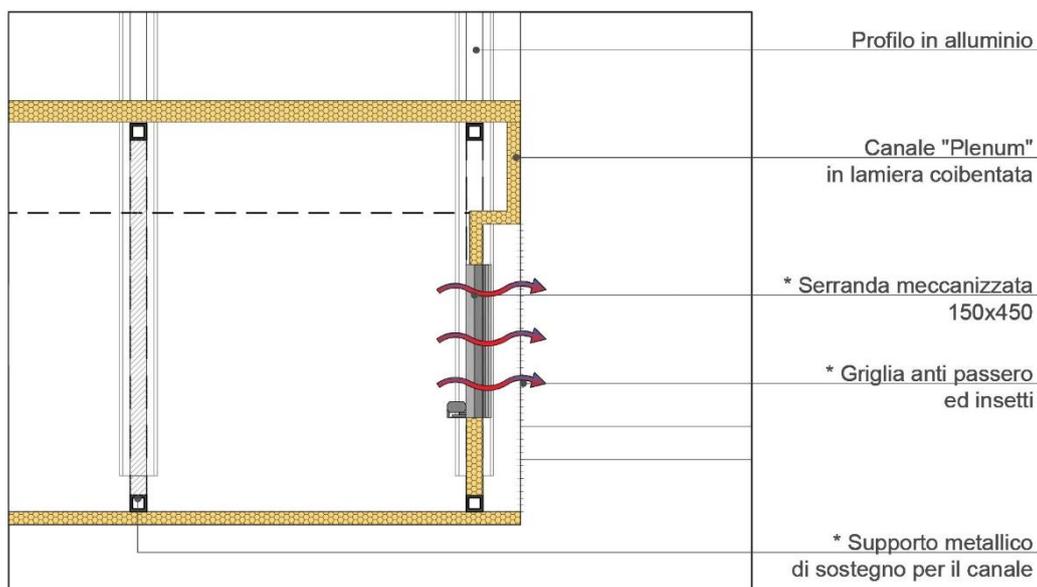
Sezione orizzontale canale “Plenum” – Serrande meccanizzate
